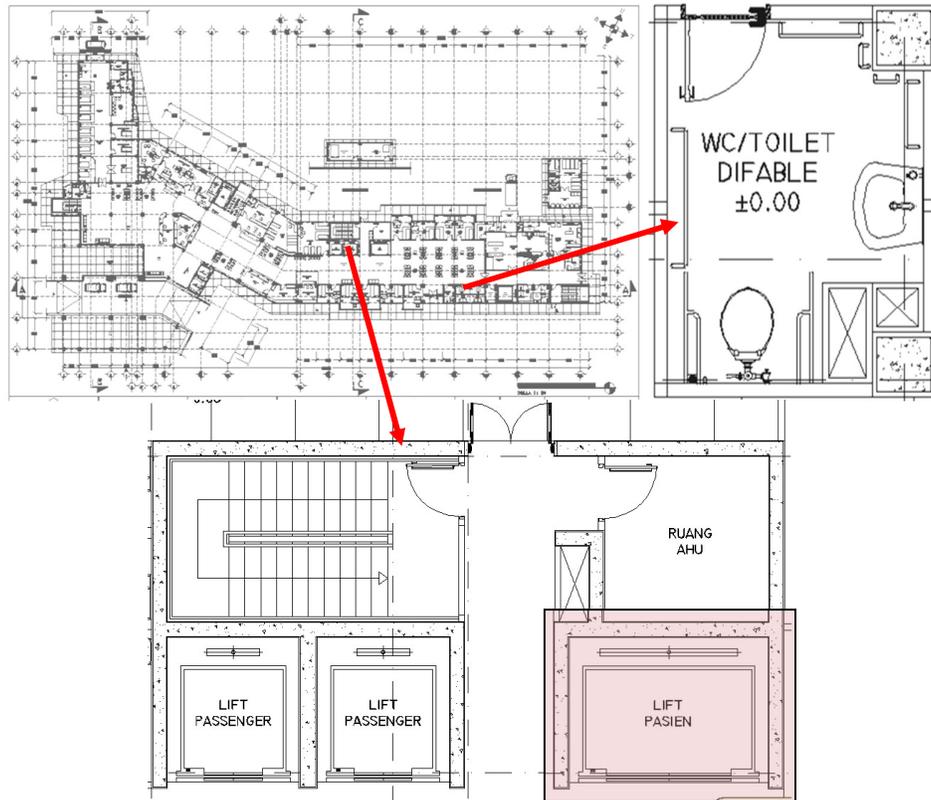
Analisa Zonasi Ruang Pada Bangunan
